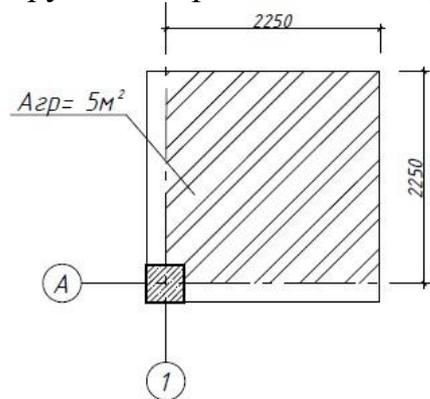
Грузовая площадь крайней-сжатой колонны по осям А–1.
